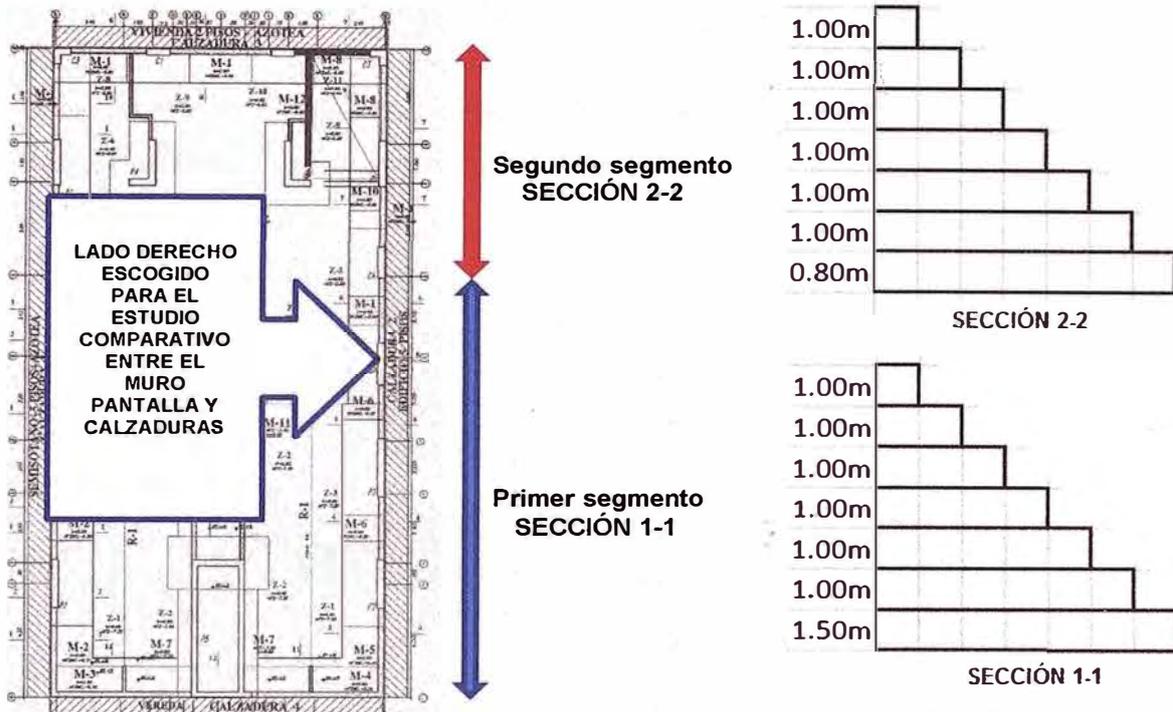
Plano de cimentación y secciones de calzaduras
